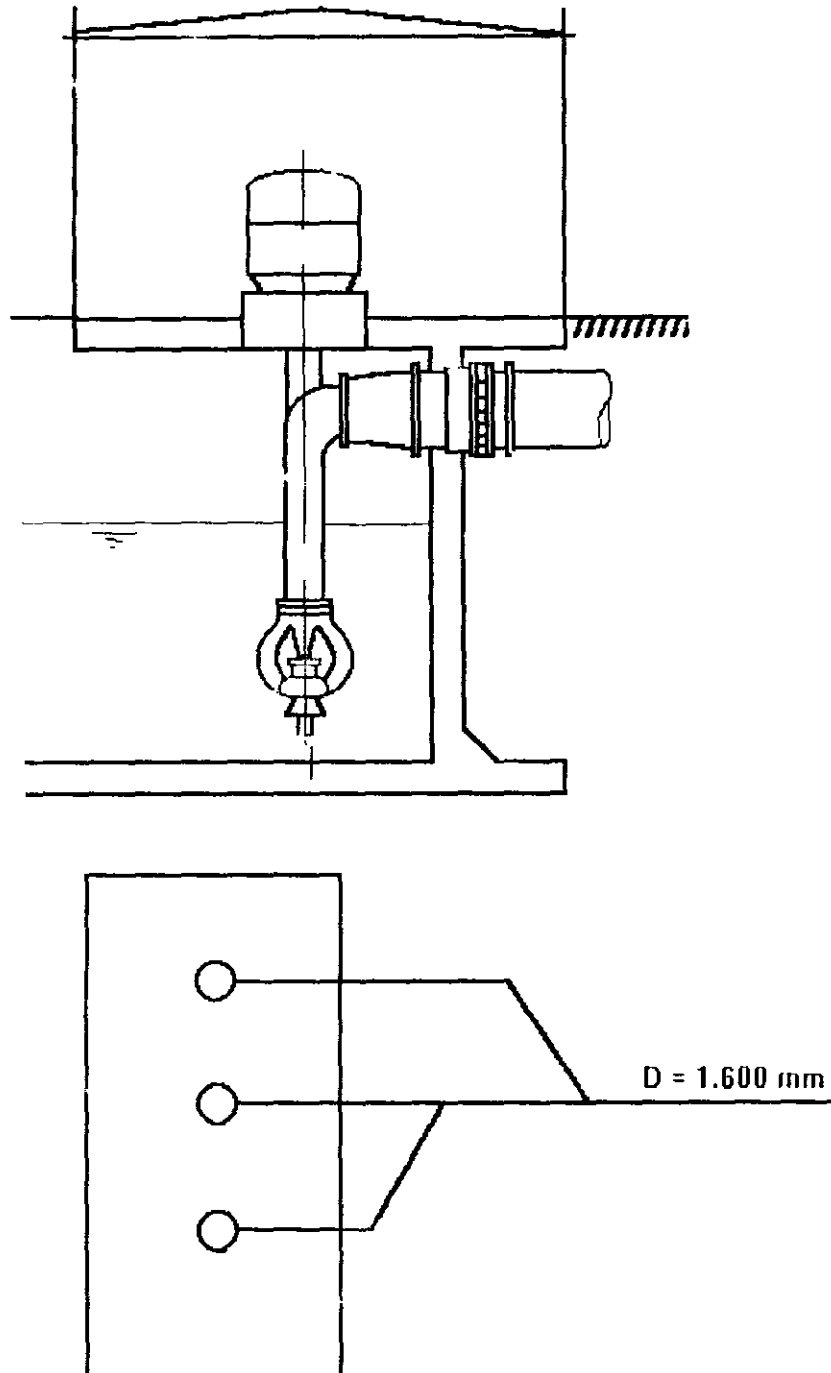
5 - Arranjo da Estação Elevatória Principal - Alternativa 2
